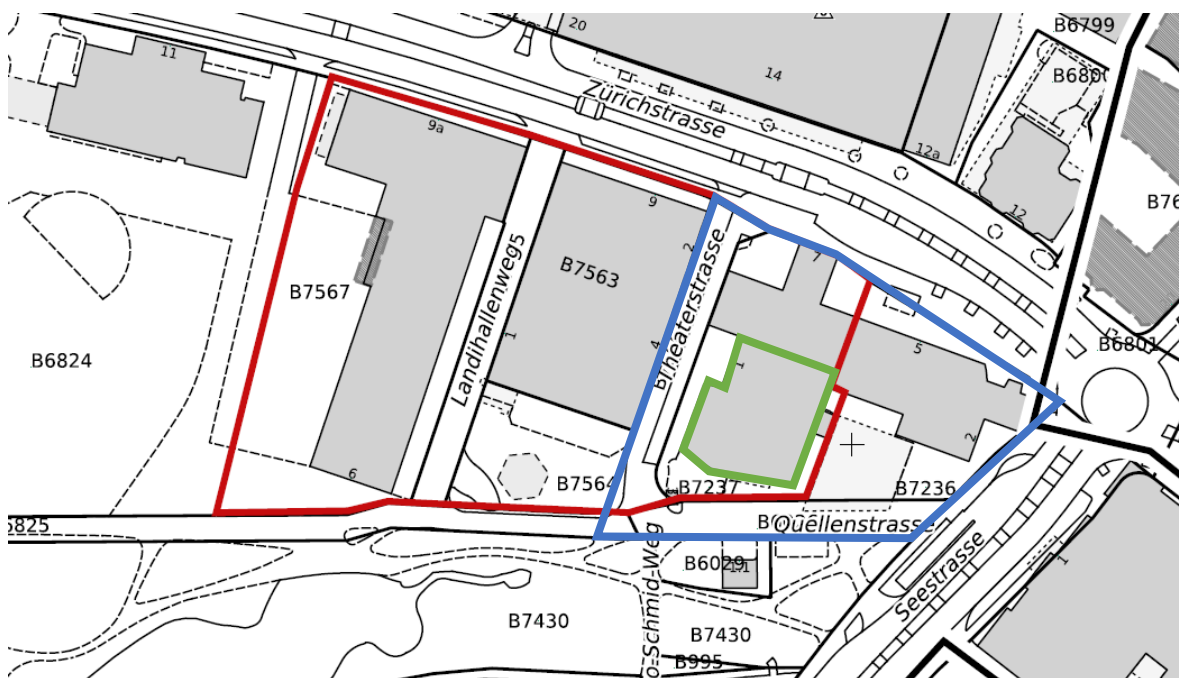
Situationsplan (rot: Perimeter Masterplan «Areale am Stadtpark», grün: Stadthofsaal, blau: Perimeter strategische Planung)
